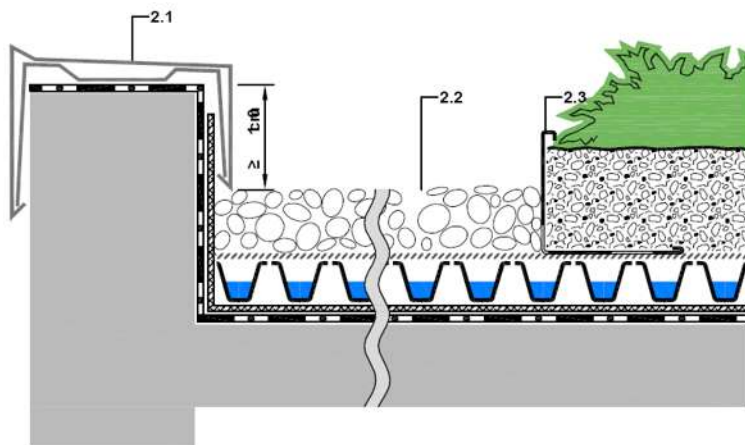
Detalle constructivo en murete perimetral (ZinCo, 2011)
